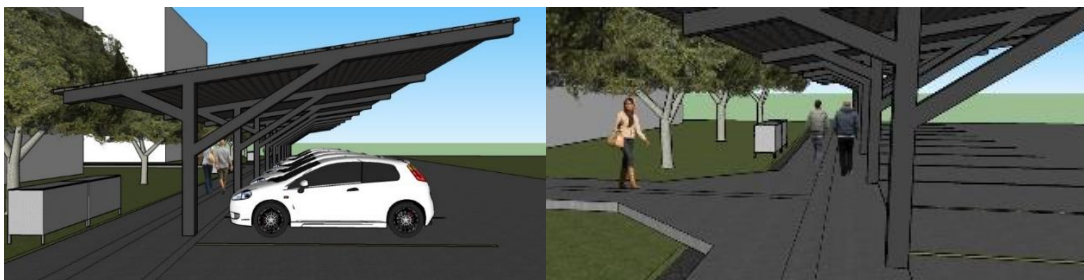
Cobertura metálica proposta para o estacionamento. Fonte: elaborado pelos autores.
